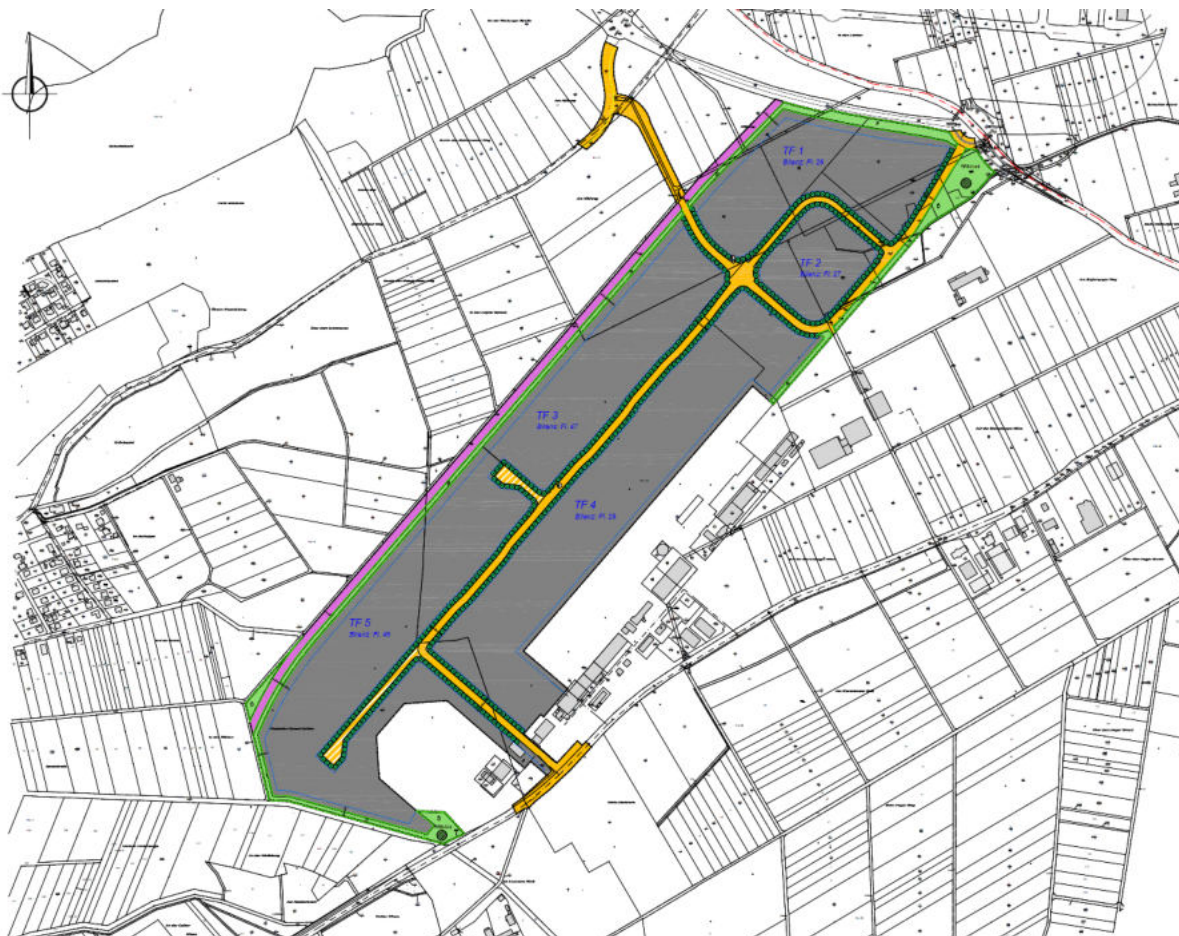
B-Plan Entwurf (Details siehe Anlage 1)
